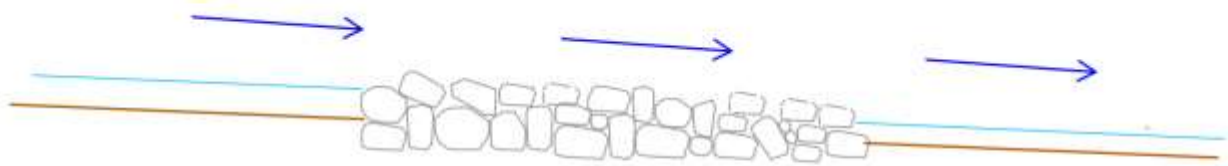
Schema tipologico di intervento. Rifacimento del guado.
